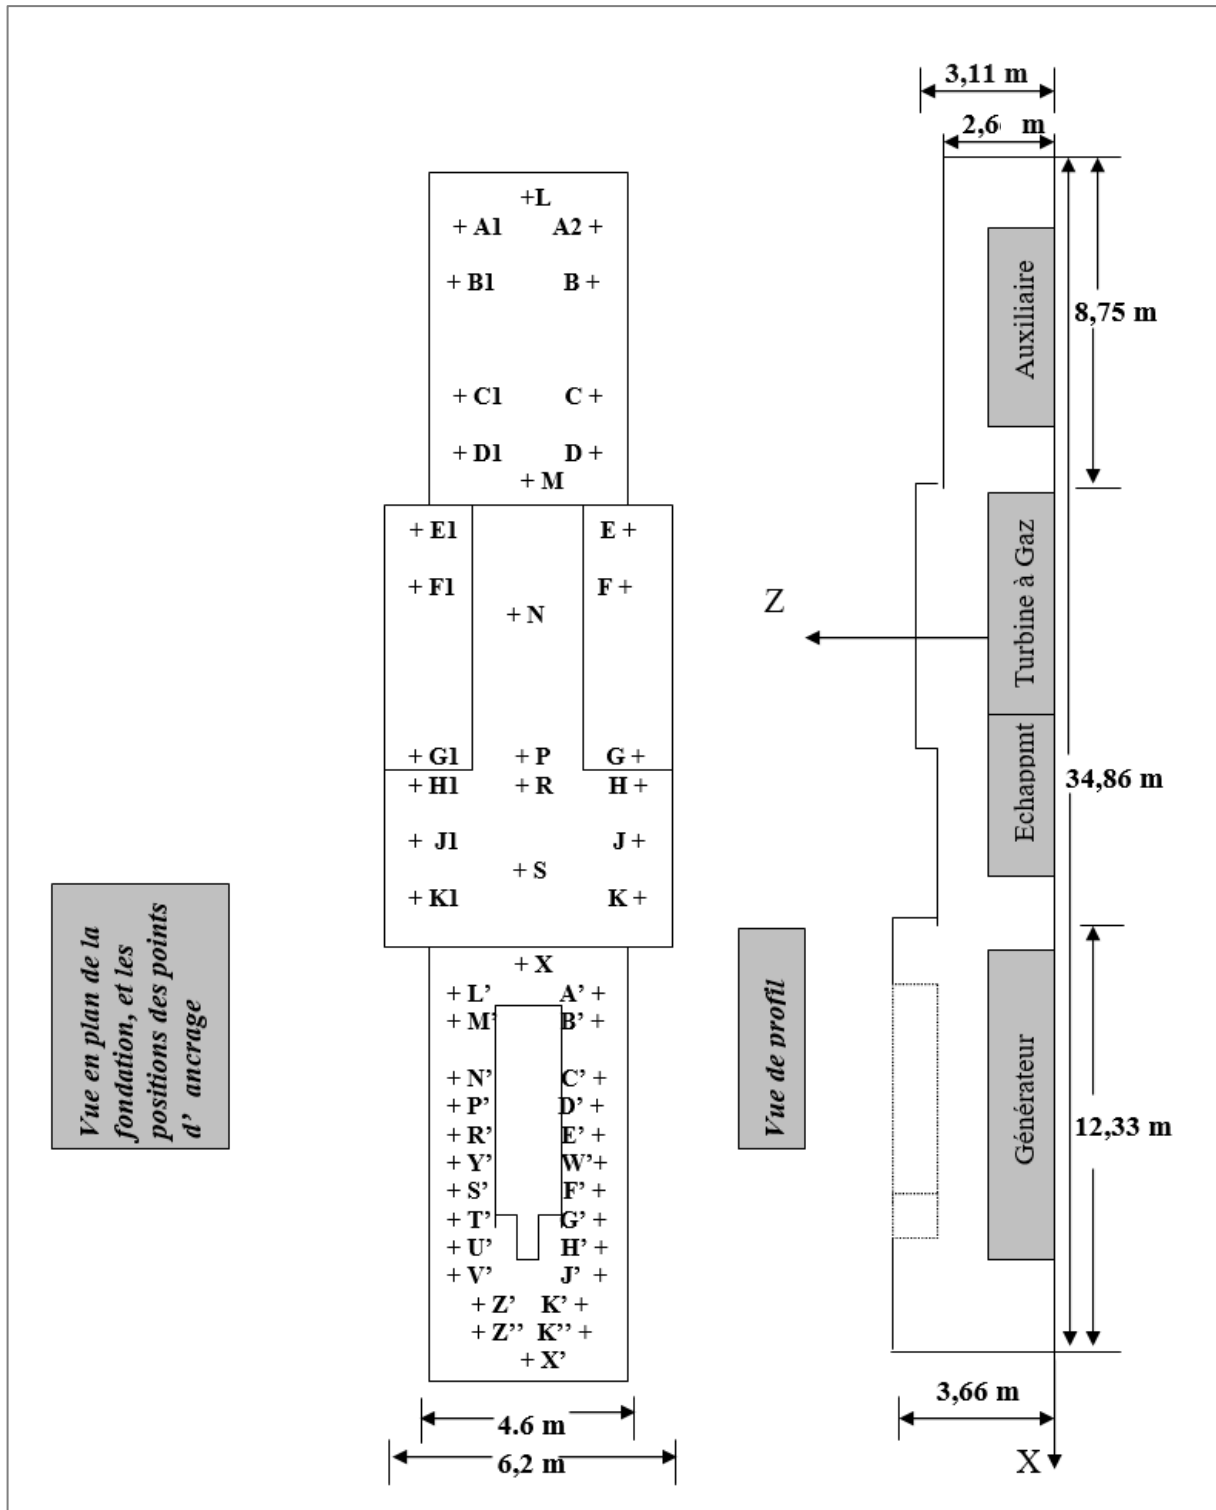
Vue en plan et de profil du massif fondation de Hassi Barkine.
